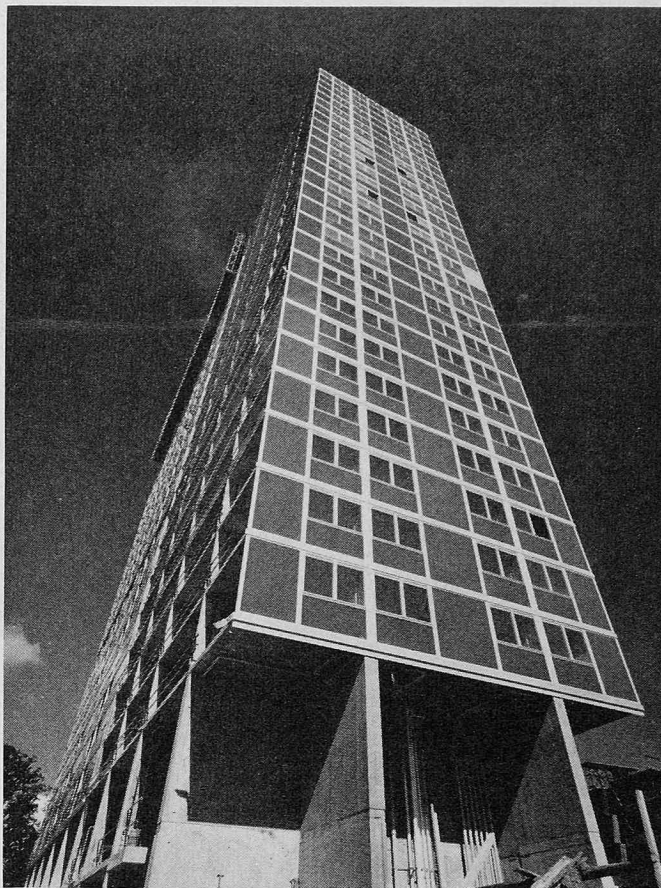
Hochhaus mit 26 Etagen, Schmalseite, Fassade in Verbundkonstruktion (Aluminium, Holz, Glas)
